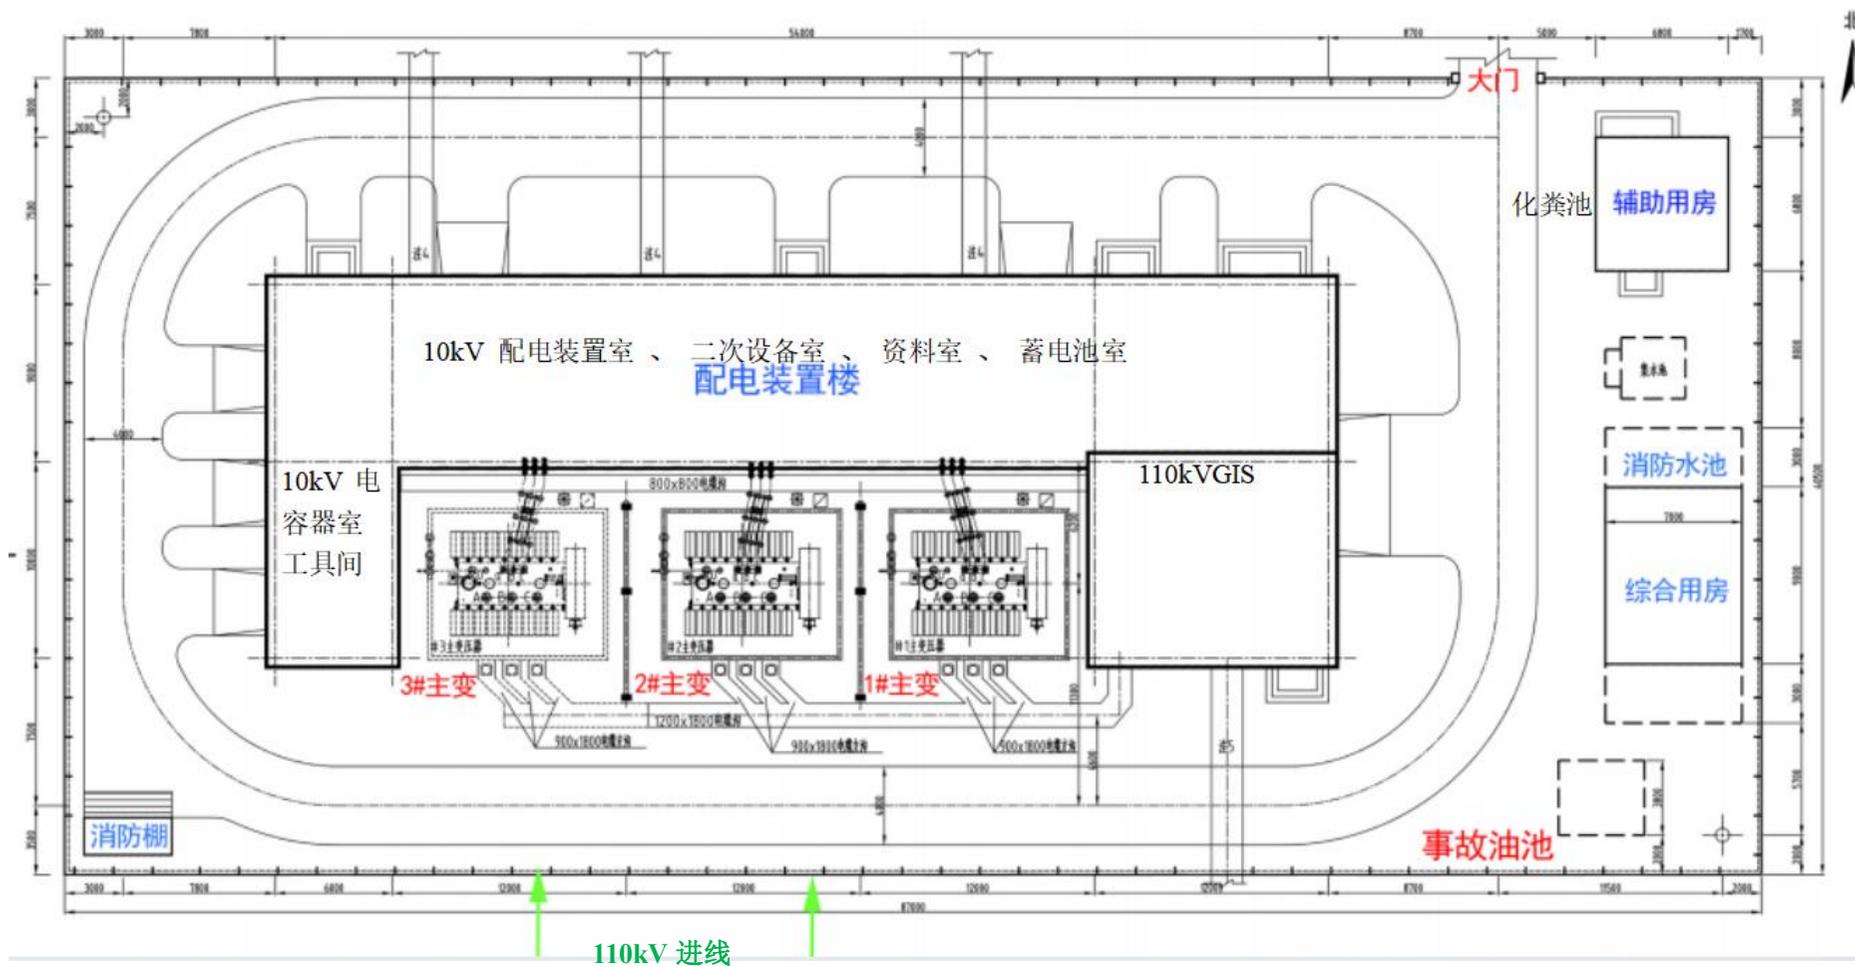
泰安宁阳苗河 110kV 变电站平面布置图
